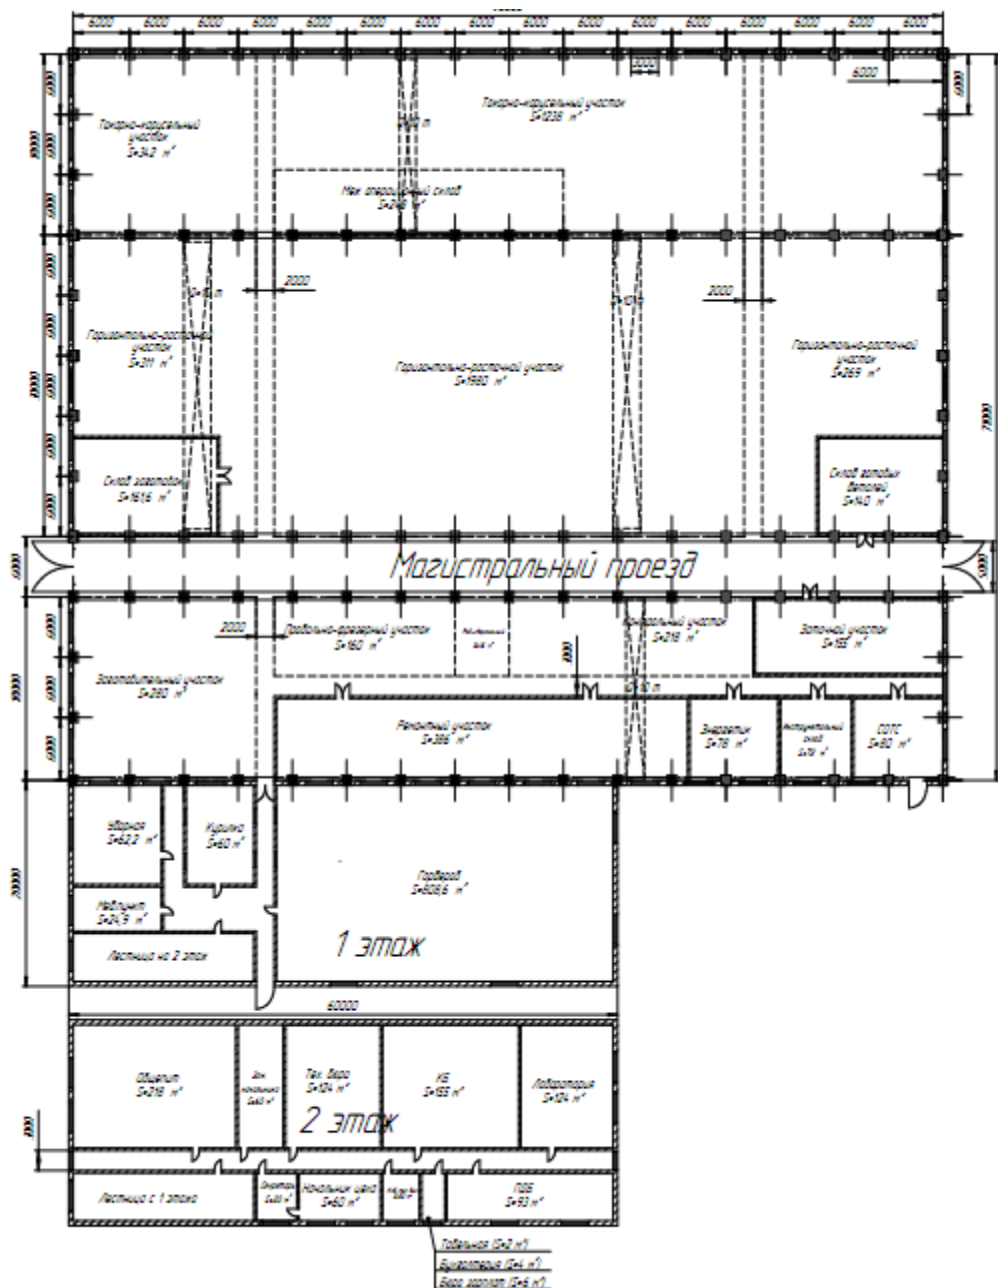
Планировка механосборочного цеха АО «Тяжмаш»
